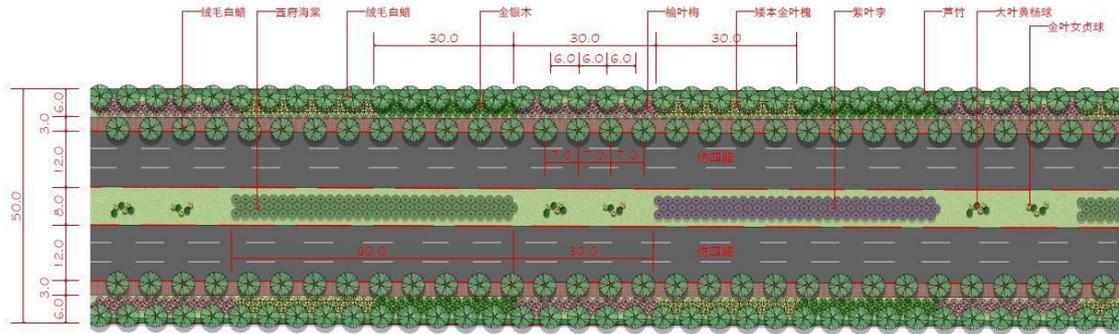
纺四路（轻四街至轻五街）标准段局部平面图
